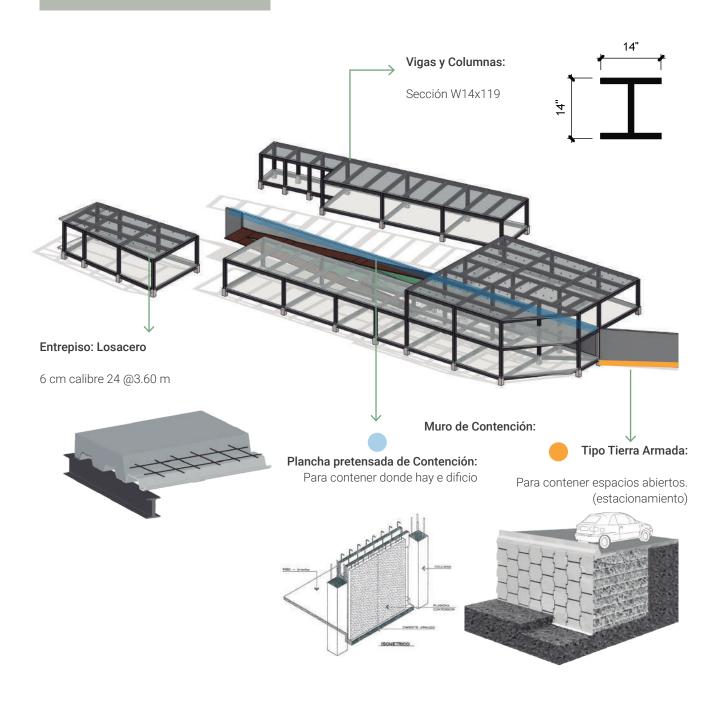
, Vista 3D de Estructura de Proyecto. Elaboración Propia.
